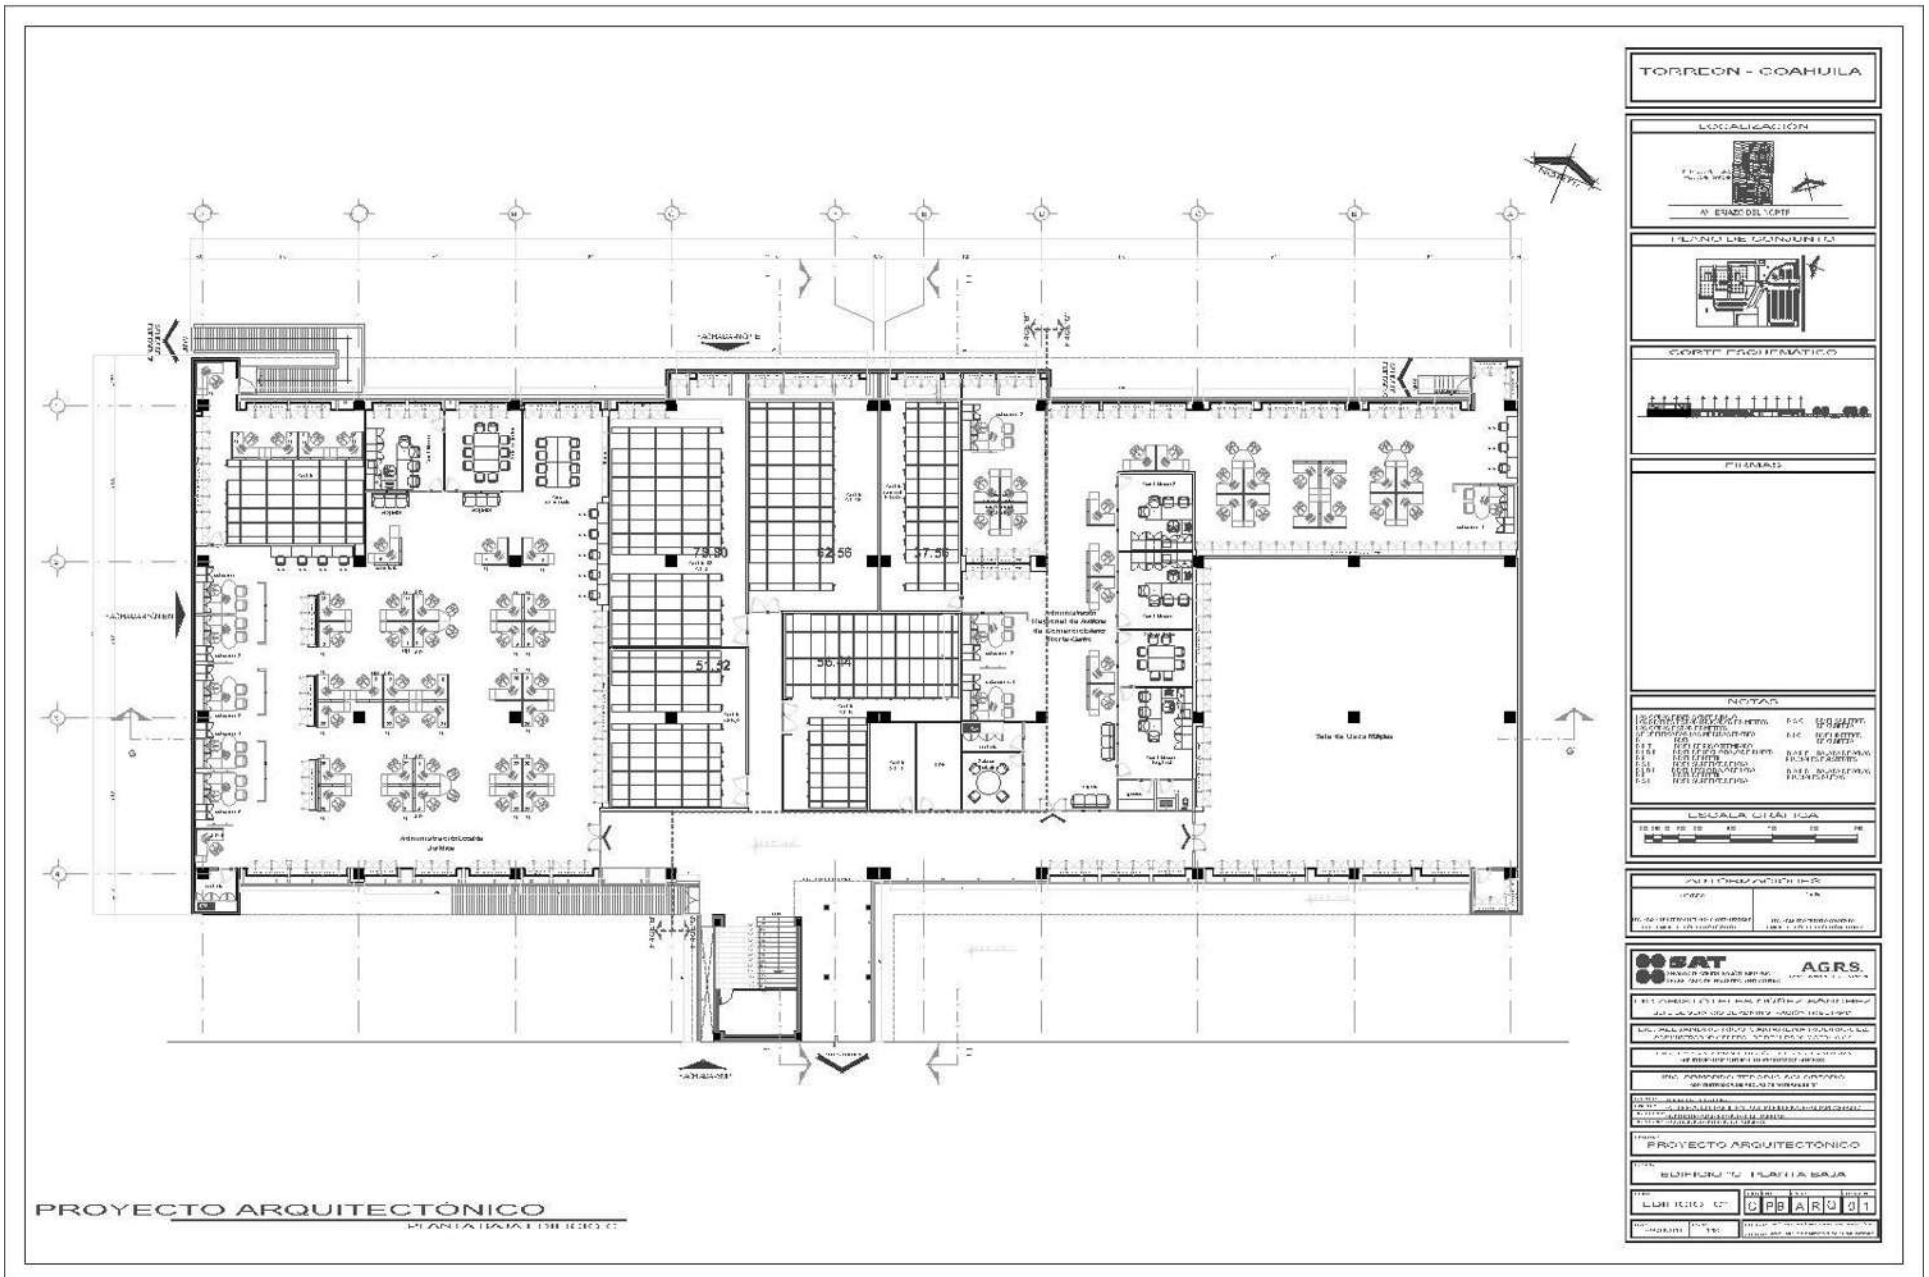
C-PB-ARQ-01 Planta arq. edificio C
